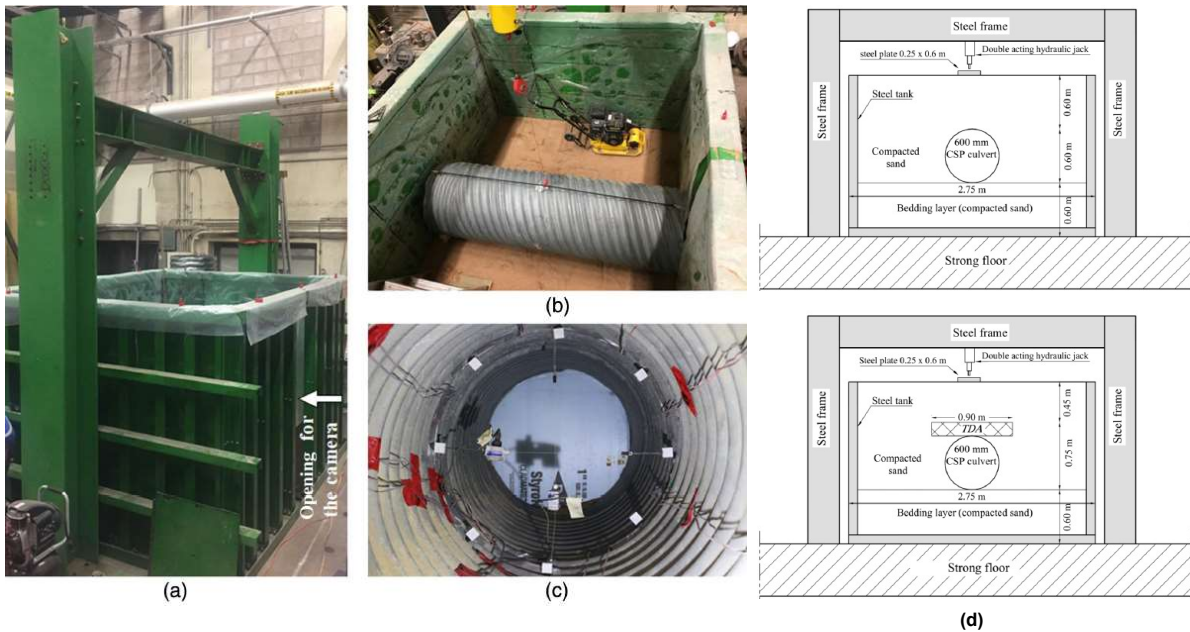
Vista do ensaio da galeria de aço corrugado
